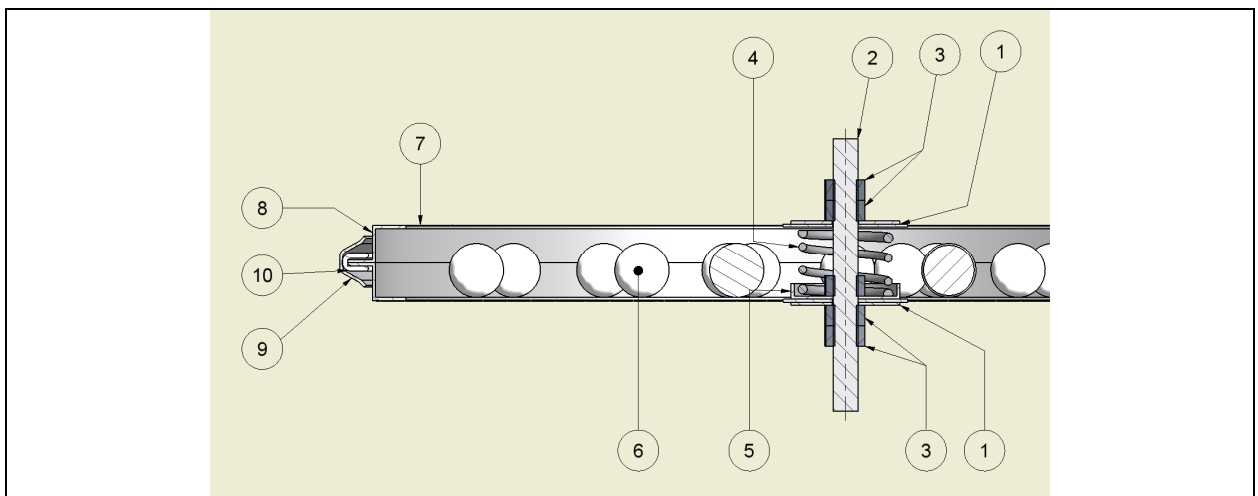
Sezione accessorio PALLE senza fascia distanziale
